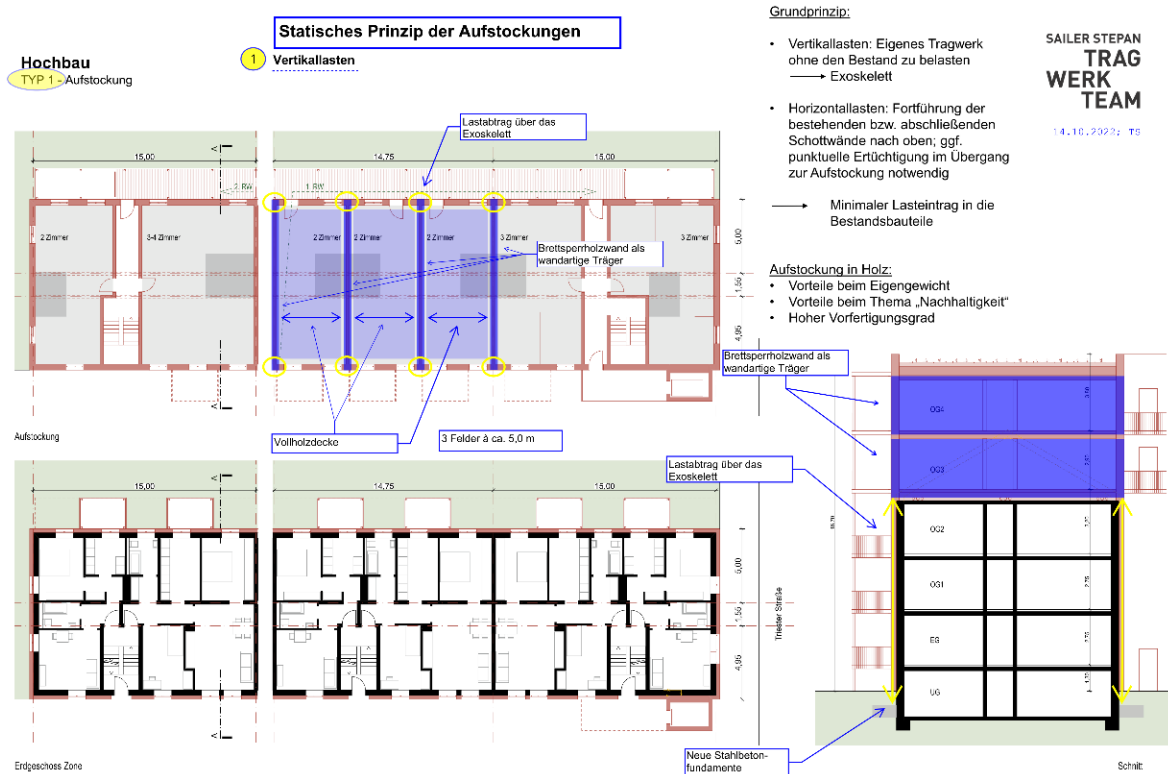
Lastabtrag der Vertikallasten, Sailer Stepan Tragwerksteam
